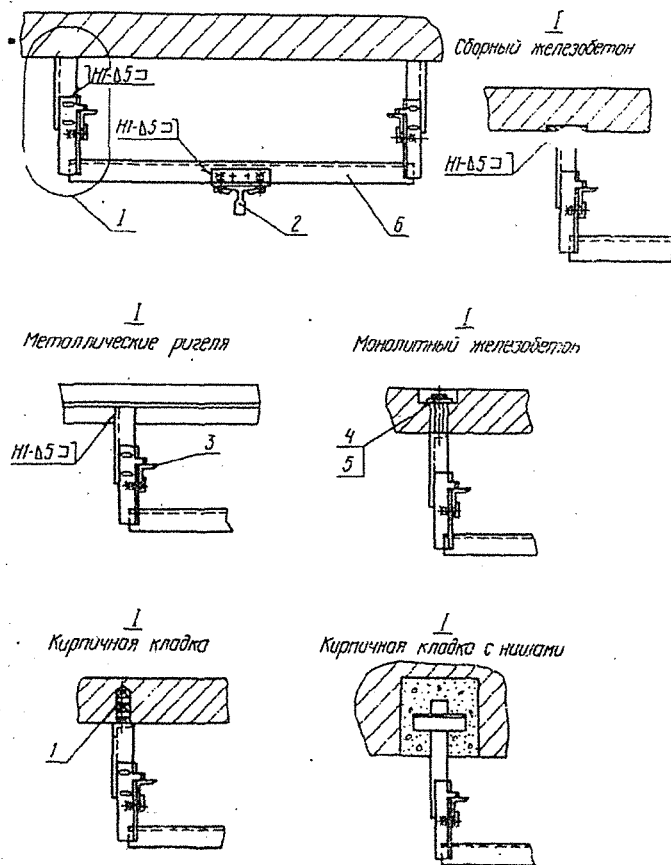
Крепление направляющих кабины и противовеса при боковом его расположении:
